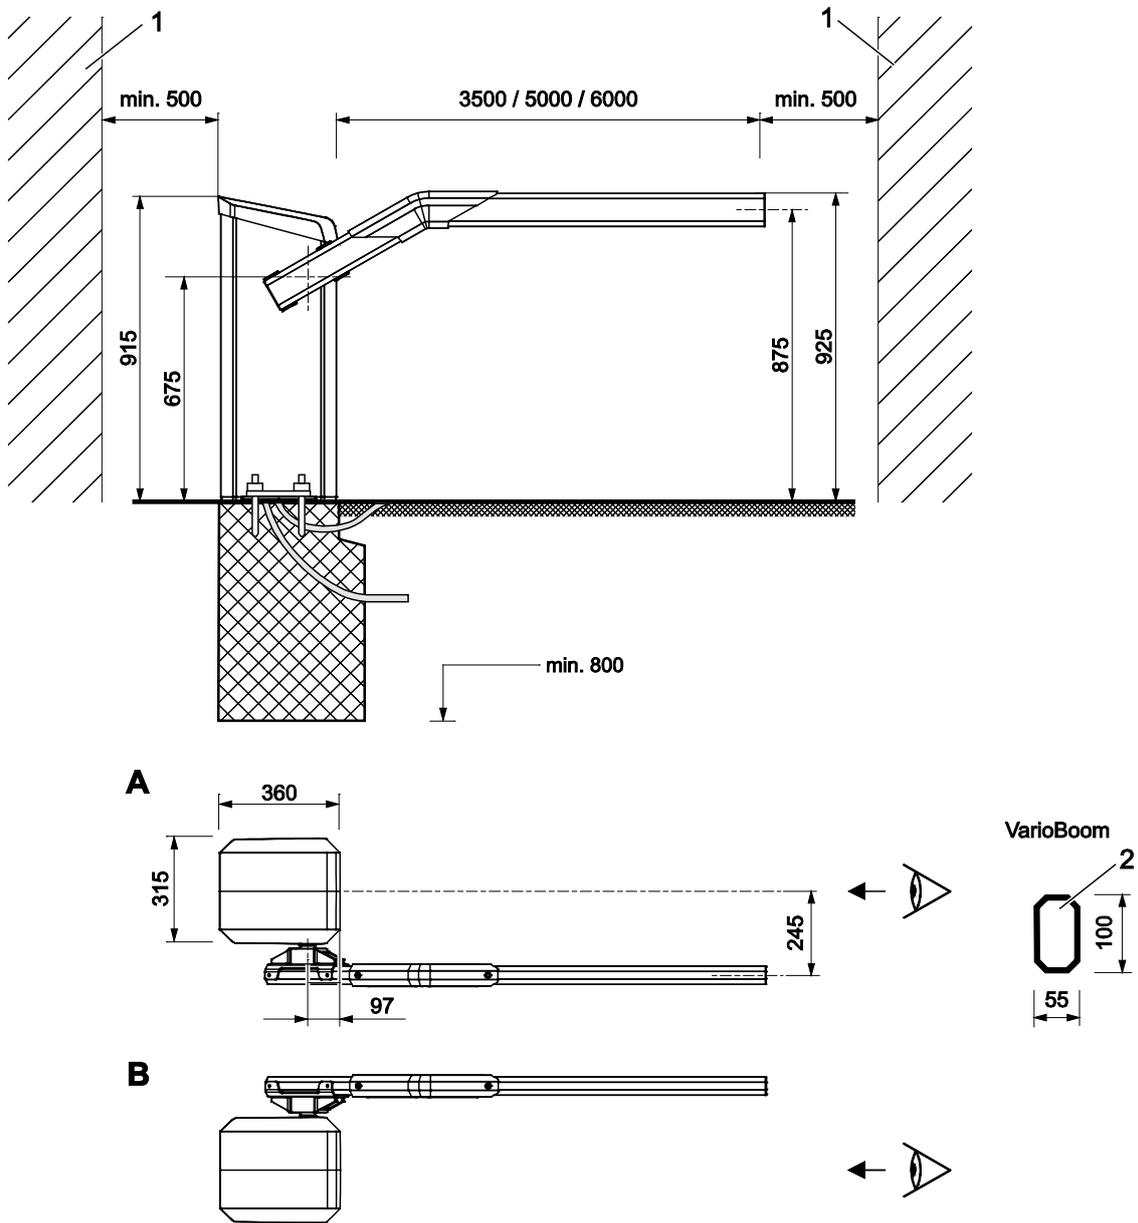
Abmessungen Schrankenanlage und Schrankenbaumprofil – Serie "Access" (Maße in mm)
